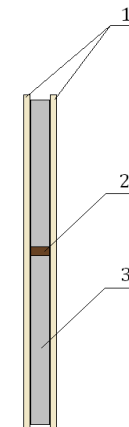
Принципиальная конструкция стеновой, половой и кровельной панелей
